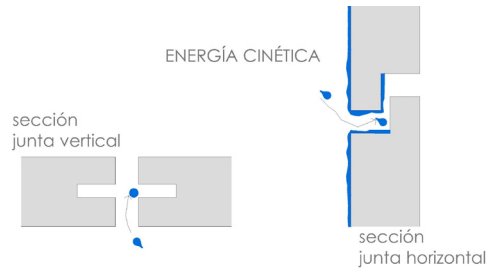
Esquema de la energía cinética en junta vertical acanalada y horizontal rebajada.
